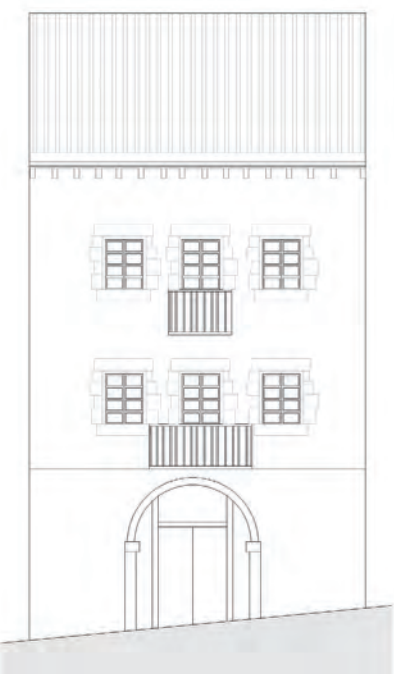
5. ALZADO A ITURRIAGA KALEA
